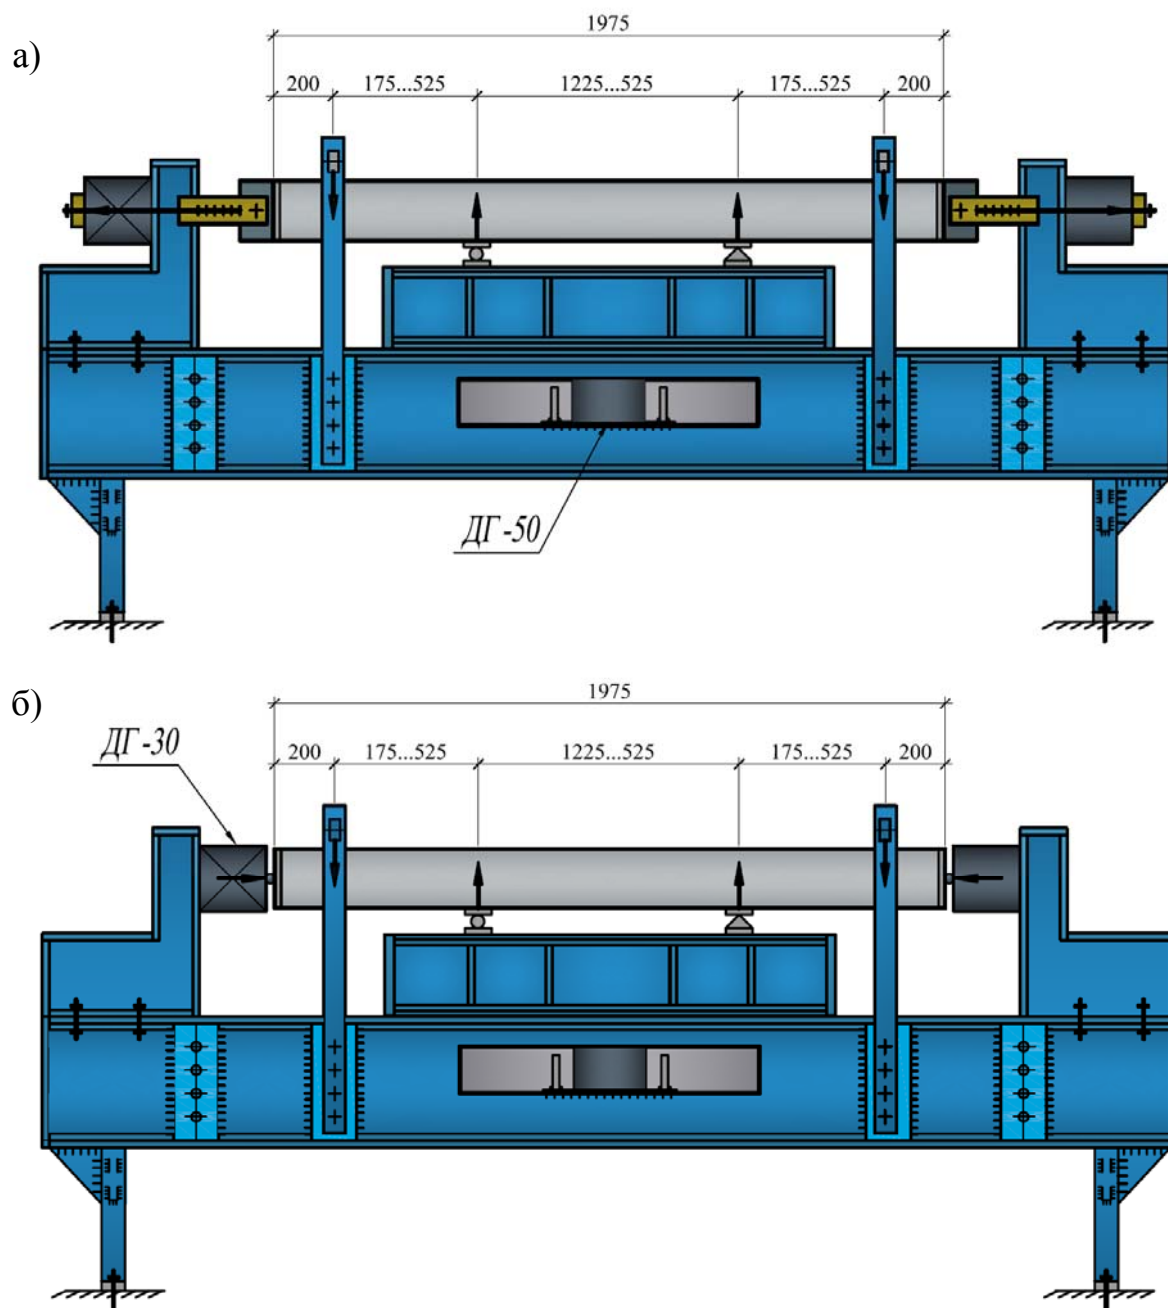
Конструкция силовой установки и схема испытания железобетонной балки на плоский поперечный изгиб с растяжением (а) или со сжатием (б).
